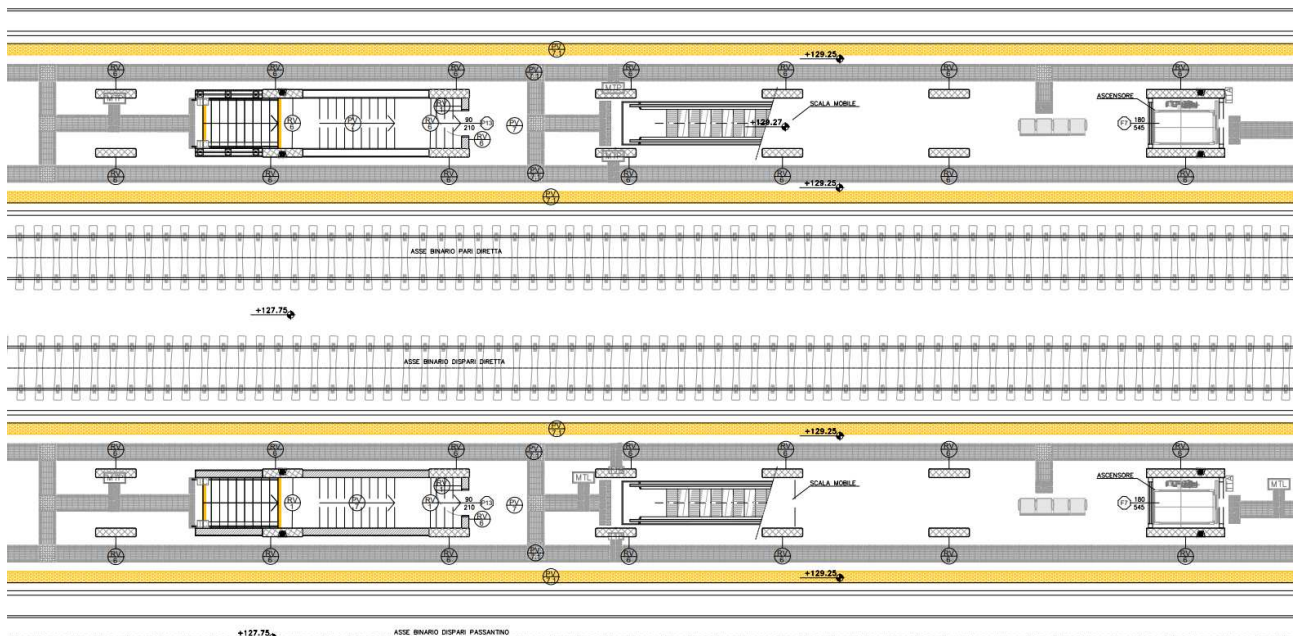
Dettaglio Pianta nuovo Piano Banchine esistente con indicazione delle finiture e dei materiali di progetto
